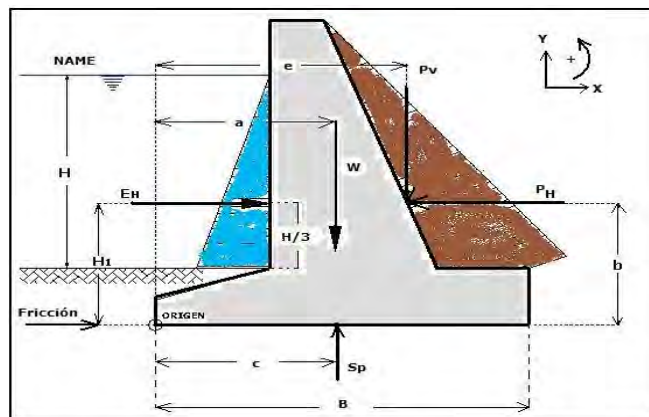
Fuerzas presentes en las subestructuras de un puente
